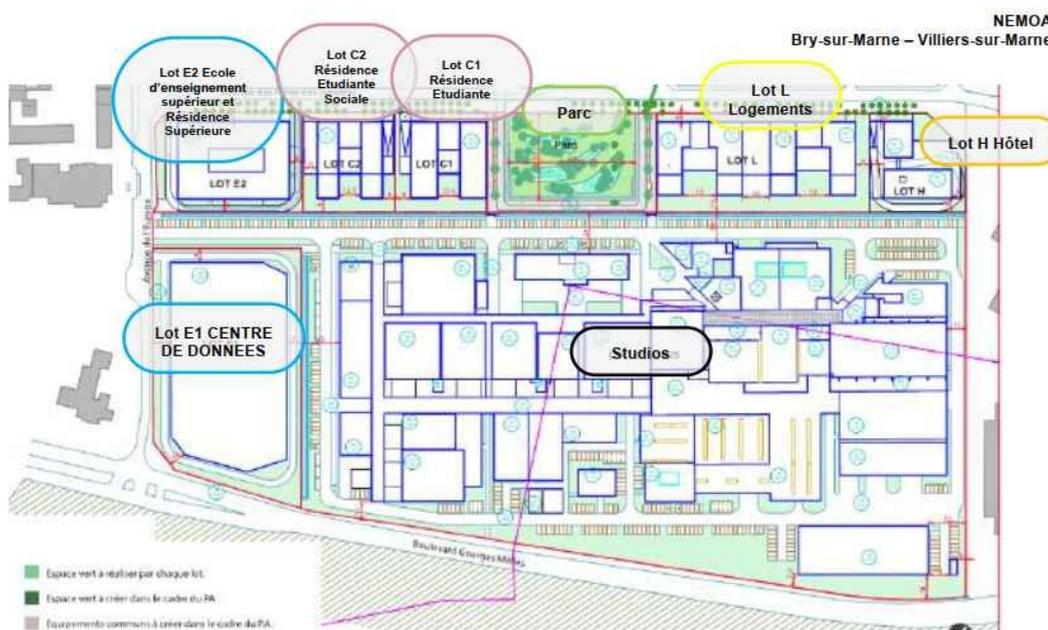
Plan d'implantation des bâtiments, source : étude d'impact, p. 122
